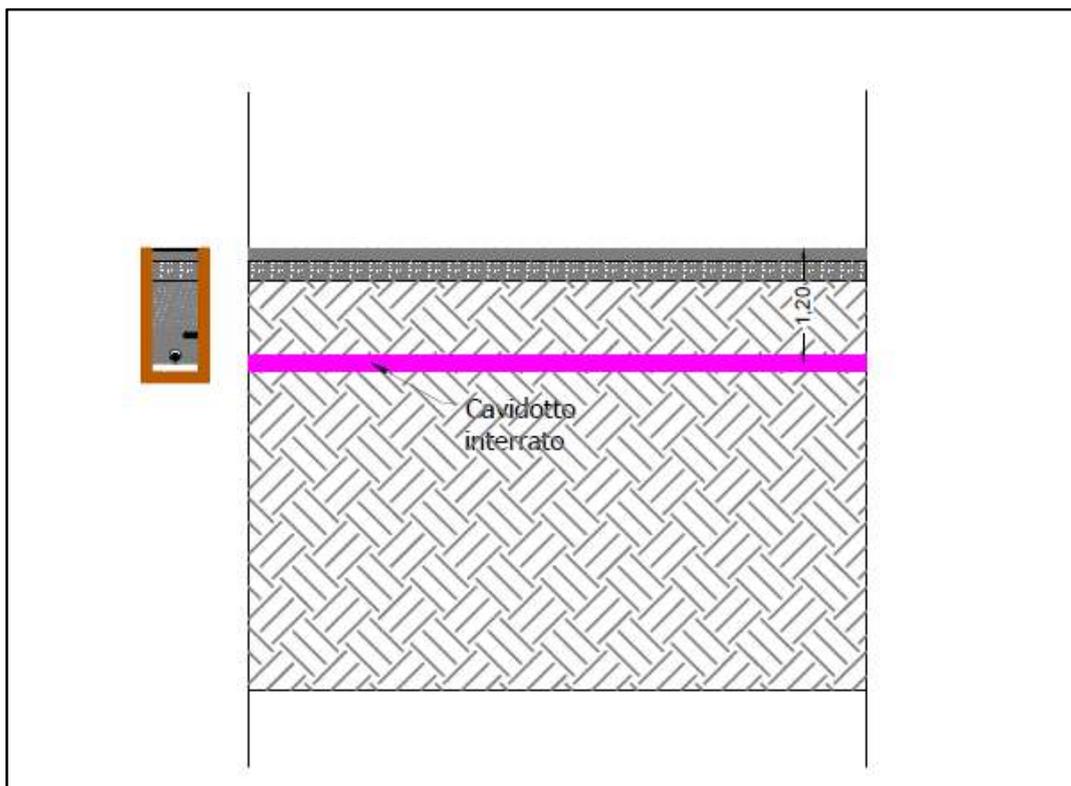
Particolare tipico attraversamento trasversale delle SP
